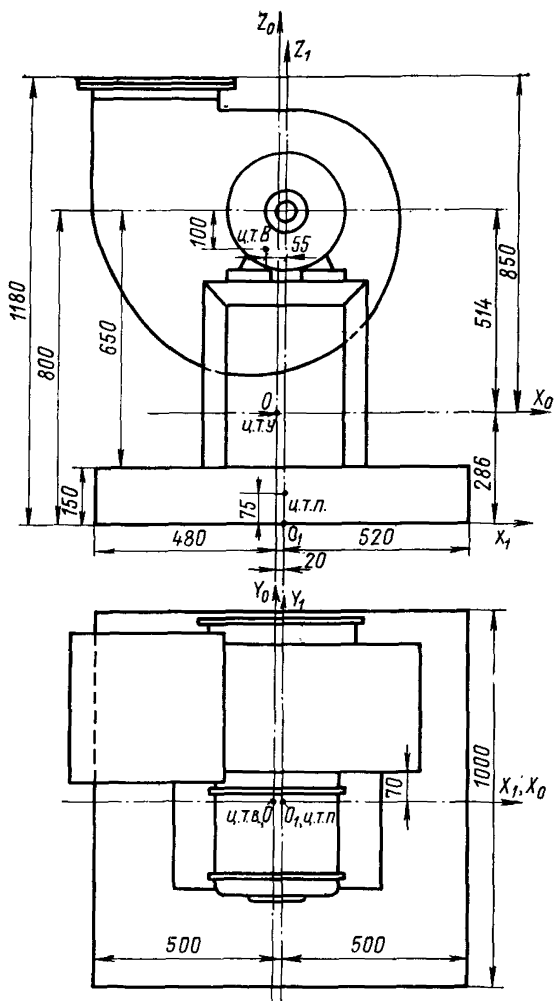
Эскиз вентилятора, установленного на железобетонную плиту
